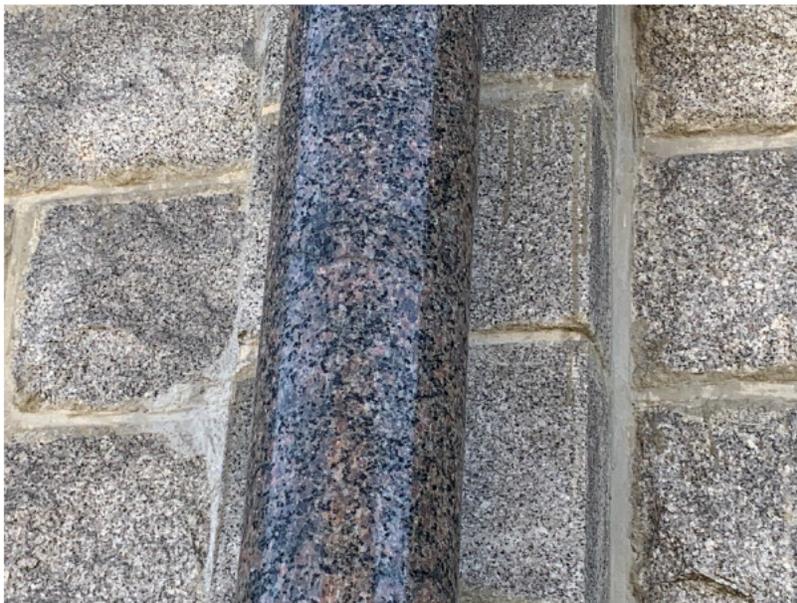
Fissure horizontale sur une colonne de granit sur la face est
